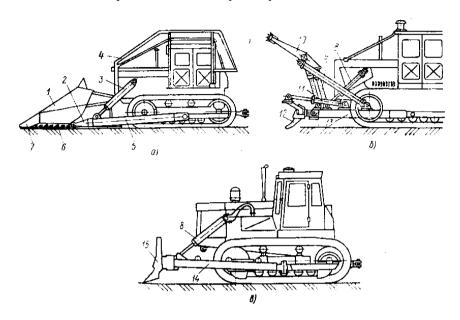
Машины для подготовительных работ: а – кусторез; б – древовал; в – корчеватель; 1 – отвал; 2 – съемная шаровая головка; 3 – гидроцилиндр подъема отвала; 4 – ограждение; 5 – универсальная рама; 6 – режущие ножи; 7 – вертикальный раскалывающий нож (колун); 8 – гидроцилиндры подъема основной рамы; 9 – гидроцилиндр изменения положения упора; 10 – упор; 11 – гидроцилиндры управления корчевателем; 12 – корчеватель; 13 – основная рама; 14 – толкающая рама: 15 – поперечные брусья с зубьями
